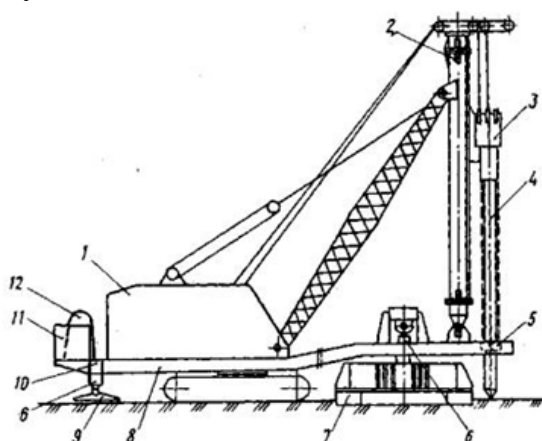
Схема сваевдавливающей установки СВО-В-1;
